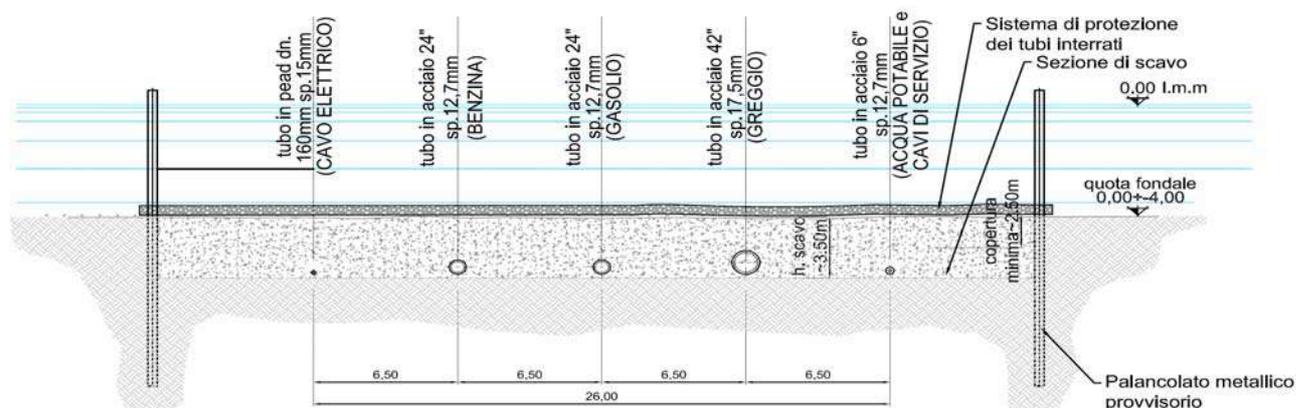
Sezione tipo del fascio tubiero dalla linea di riva sino alla batimetrica -4 m.
